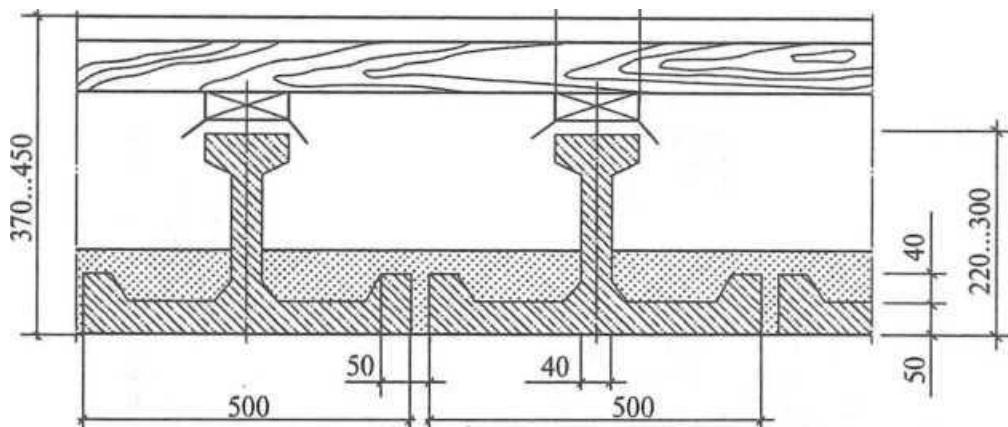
Междуетажное перекрытие из среднеразмерных балок-настилов Т-образного сечения (поперечный разрез)
